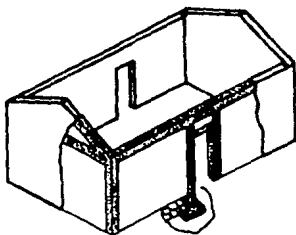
Refuerzo con elementos horizontales y verticales de concreto.
